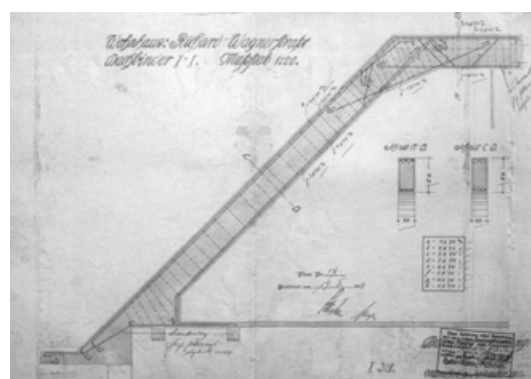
Bewehrungsplan (Basiner 2012, S. 151).
